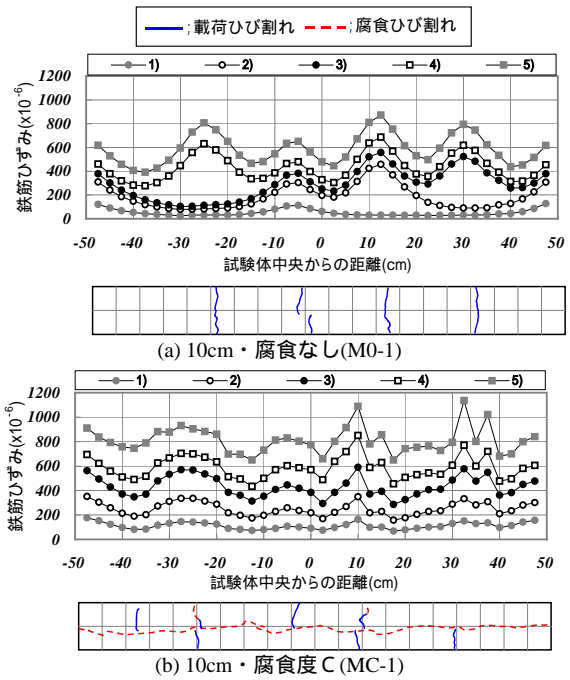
試験体の鉄筋ひずみ分布とひび割れ状況
